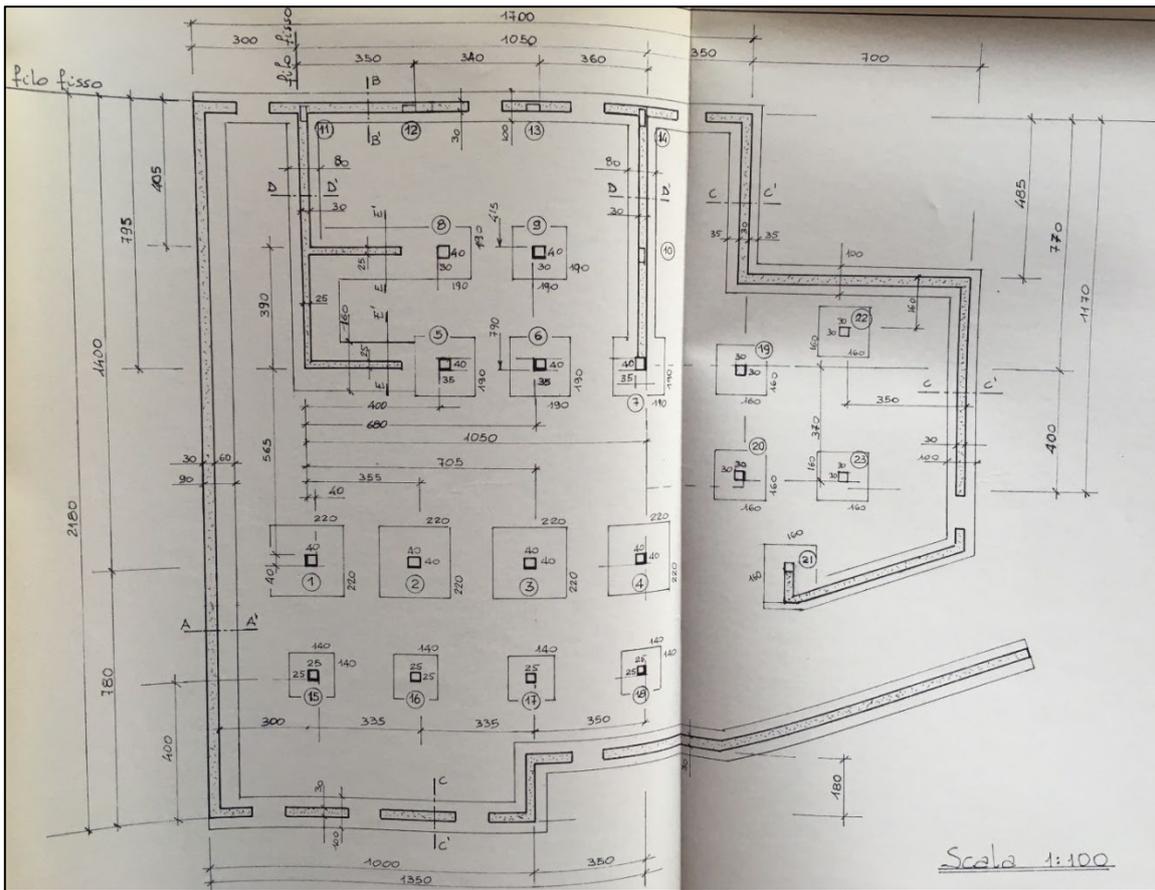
Pianta delle fondazioni dell'edificio tipo
